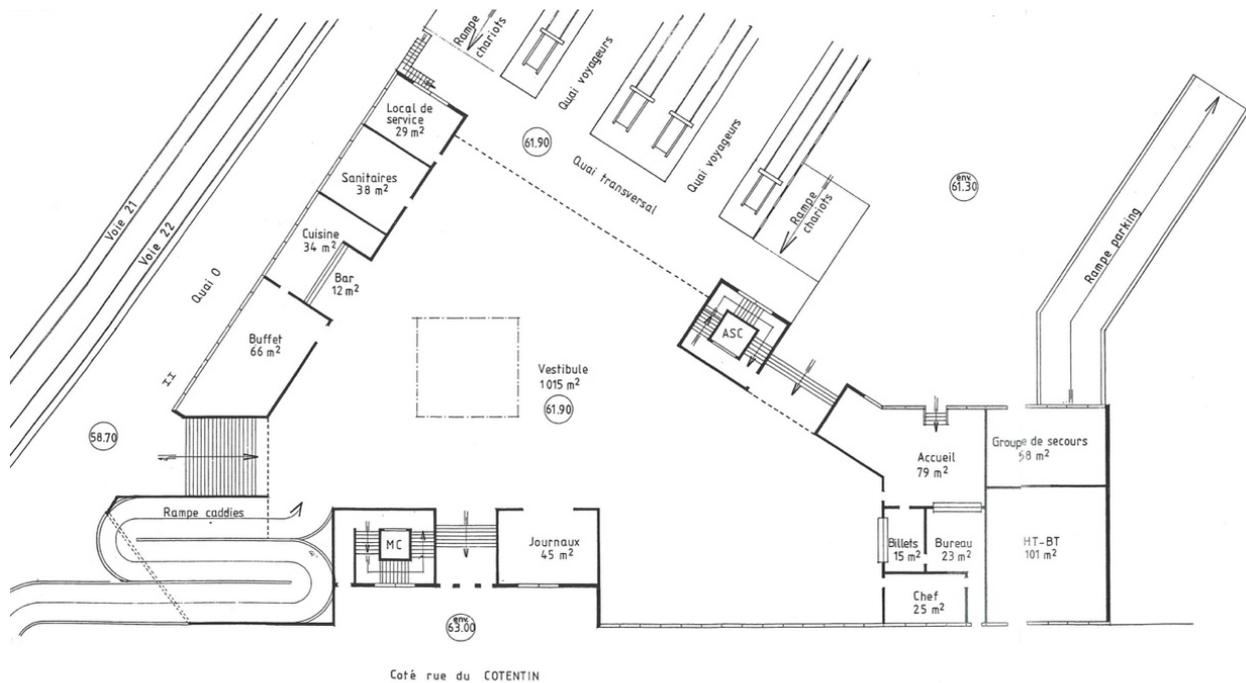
Plan du Hall 3 Vaugirard en 1983 - Source : Archives AREP
